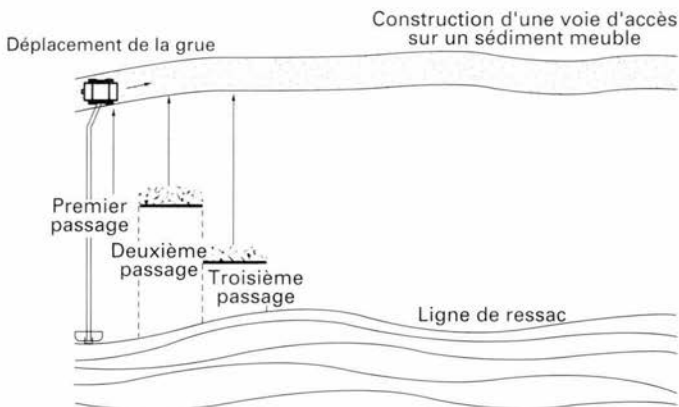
Tracé de nettoyage pour utilisation d'un excavateur à benne traînante ou d'une niveleuse hydraulique
